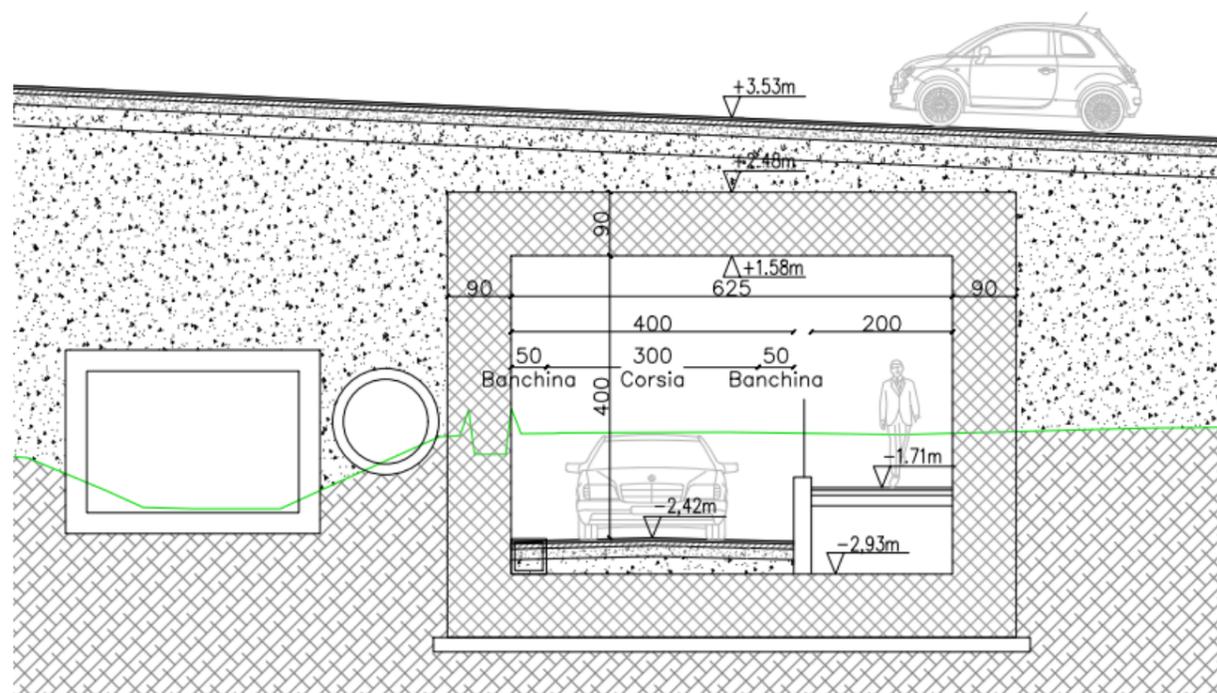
Sezione trasversale del sottopasso (da elaborato "1370.0.F.E.008.2.D.0_Sottopasso via Colombo").
